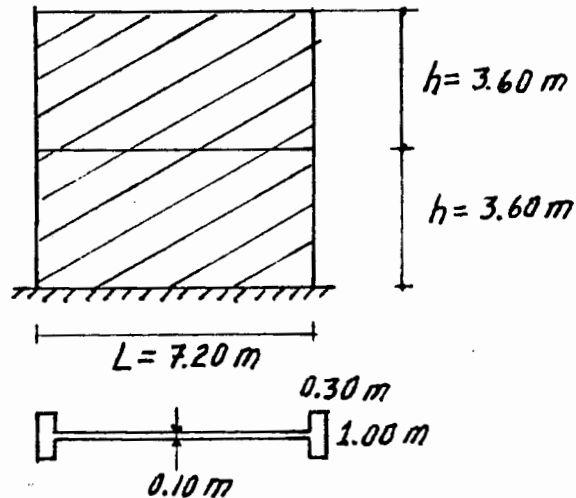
Crujía típica de un edificio escolar con muros de concreto.
